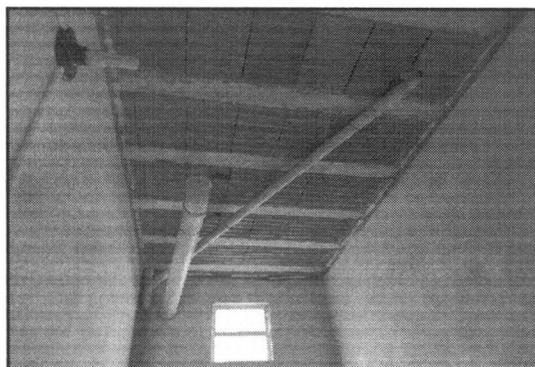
Imagem de laje do banheiro do pavimento Térreo, com tubulação aparente de esgoto
